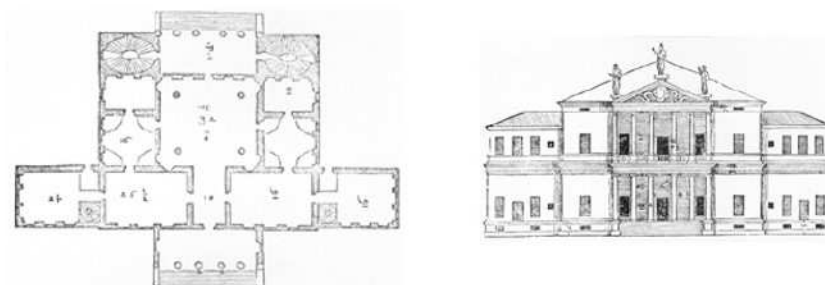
Villa Cornaro*, Planta e Alçado. (Palladio, 1570)
